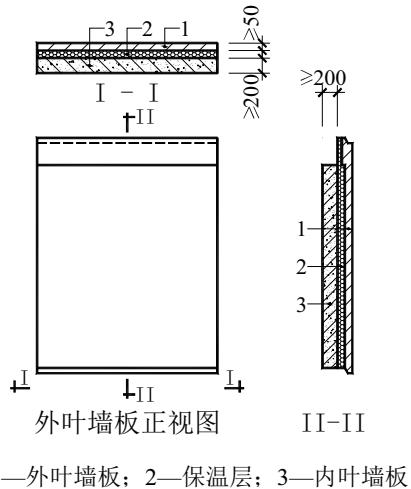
预制混凝土夹心保温外墙板构造示意
